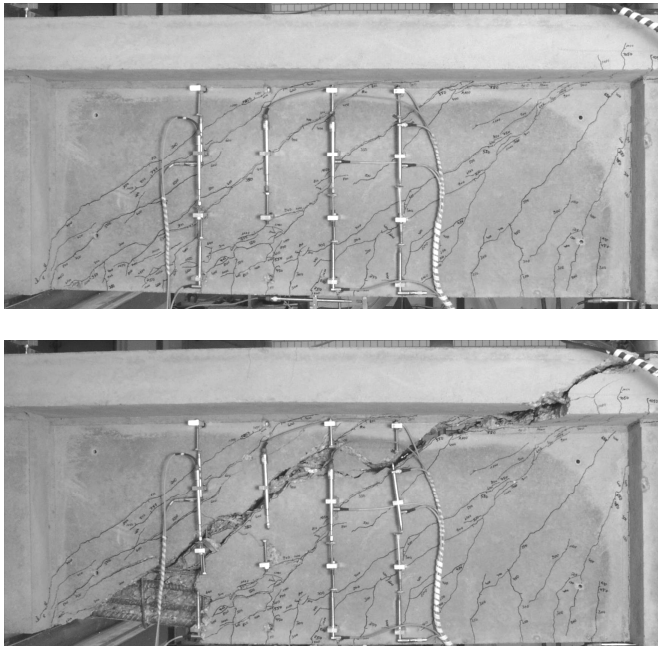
oben: Rissbild unmittelbar vor dem Bruch; unten: abschließendes Bruchbild (Ansicht der Trägerrückseite).
